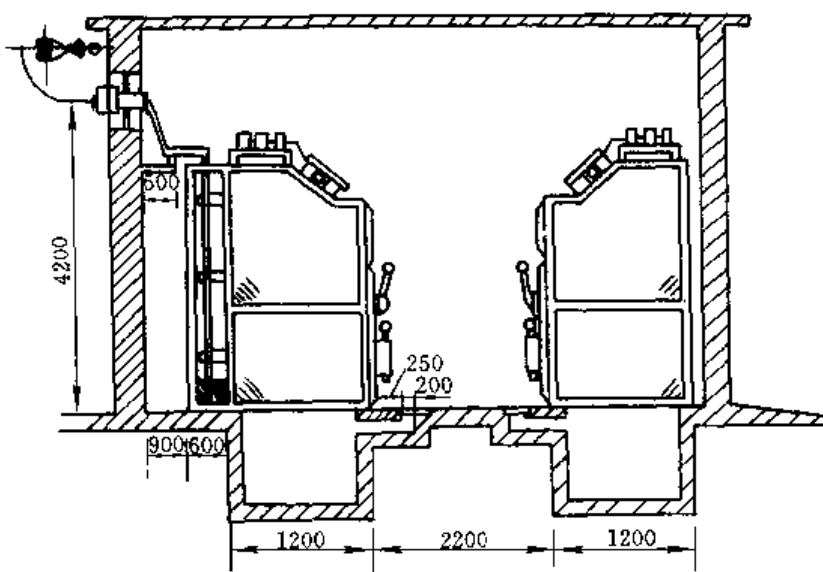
10kV 室内配电装置立体剖面图（单位：mm）
